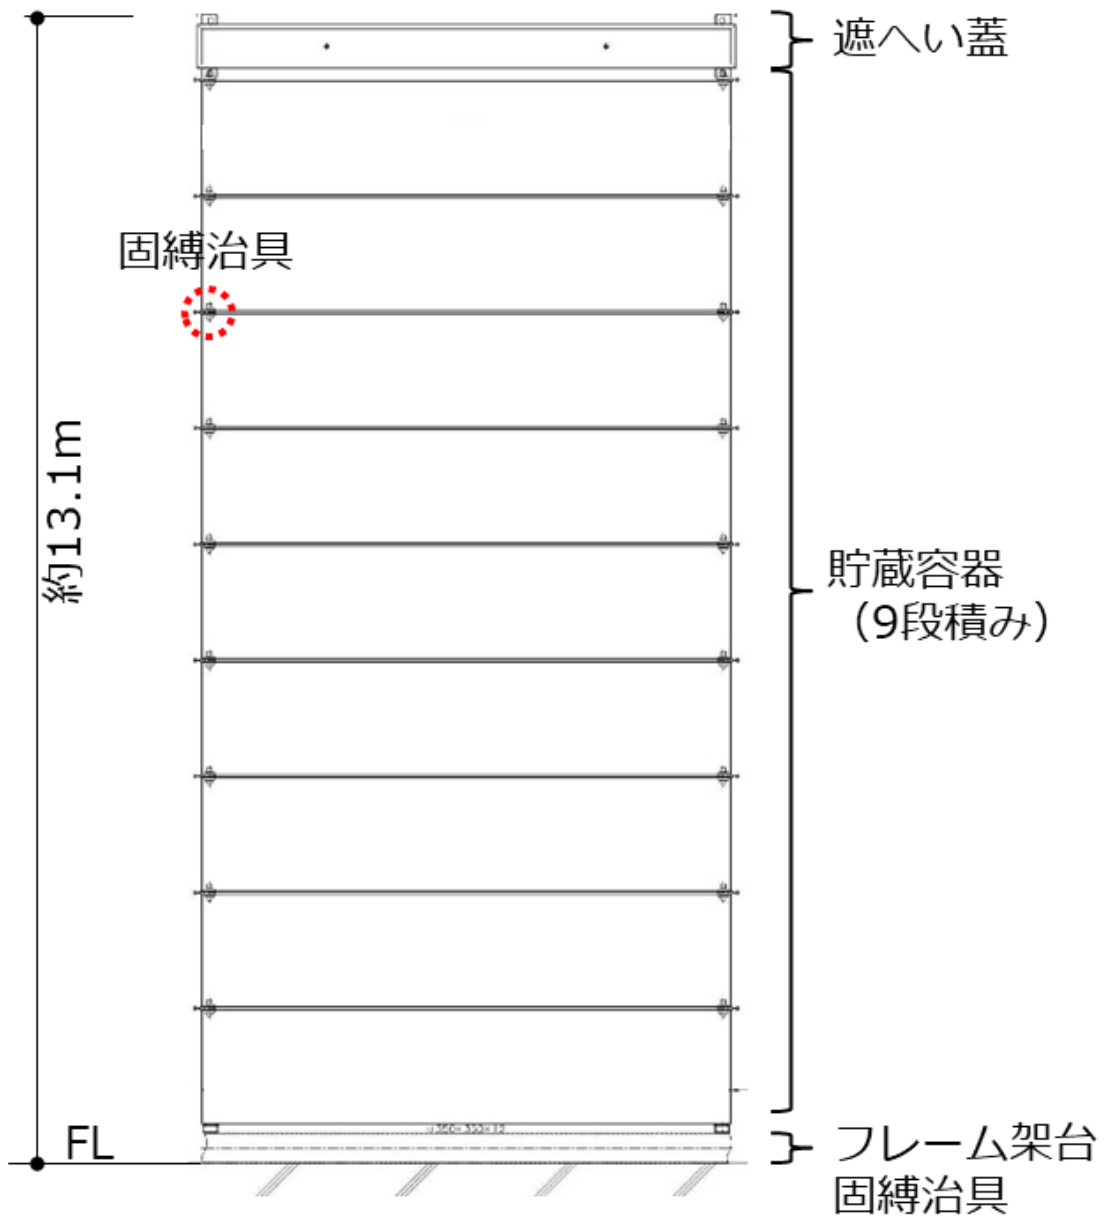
貯蔵容器 9 段積み立面図 (イメージ)
